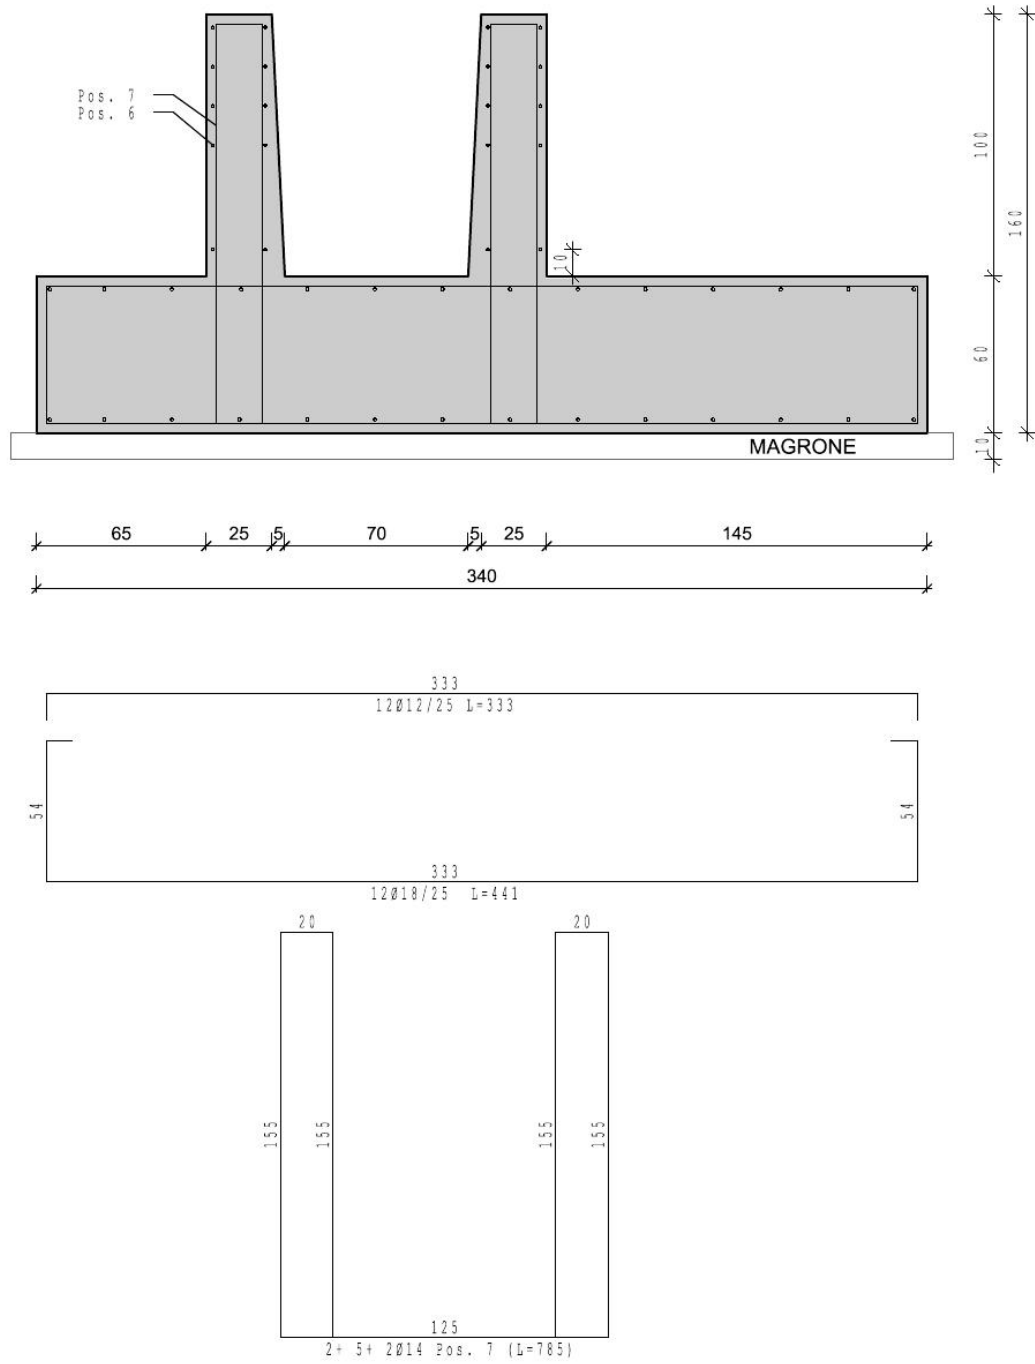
Particolare di A.2003.cap.us.T04 - Particolari plinti 8 e 9 - Sezione tipo plinto 8
